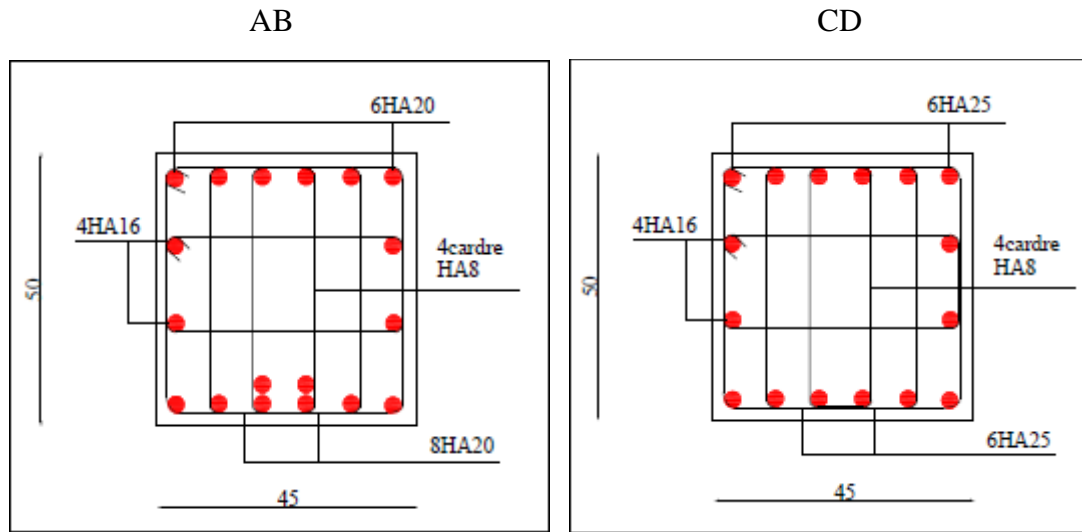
Schéma de ferrailage de la poutre de rigidité
